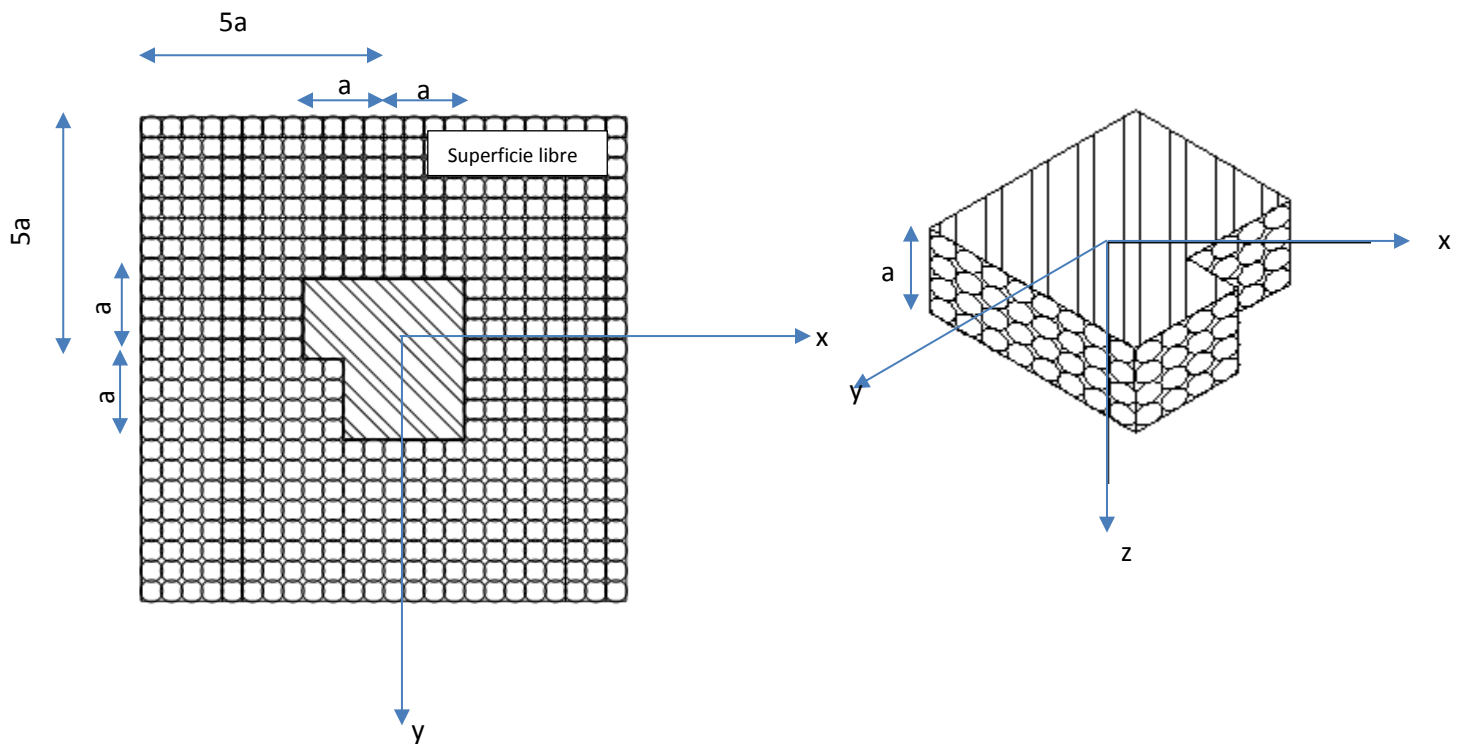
Planta y elevación de la cimentación con planta en forma de L y superficie libre discretizadas por medio de elementos circulares. Para este caso $x_b=0.5$ y $y_b=1.5$
